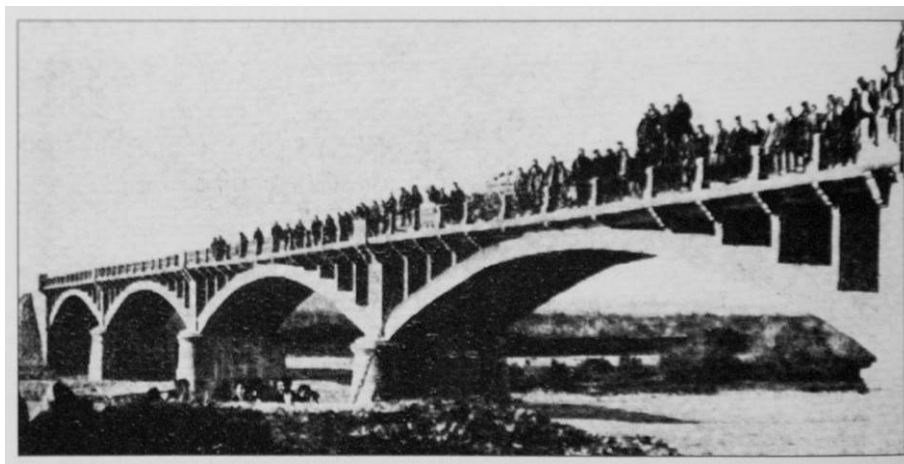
Puente sobre el río Ebro para la carretera de Calahorra a San Adrián (Navarra) 1909. Enrique Colás, ingeniero de Caminos
